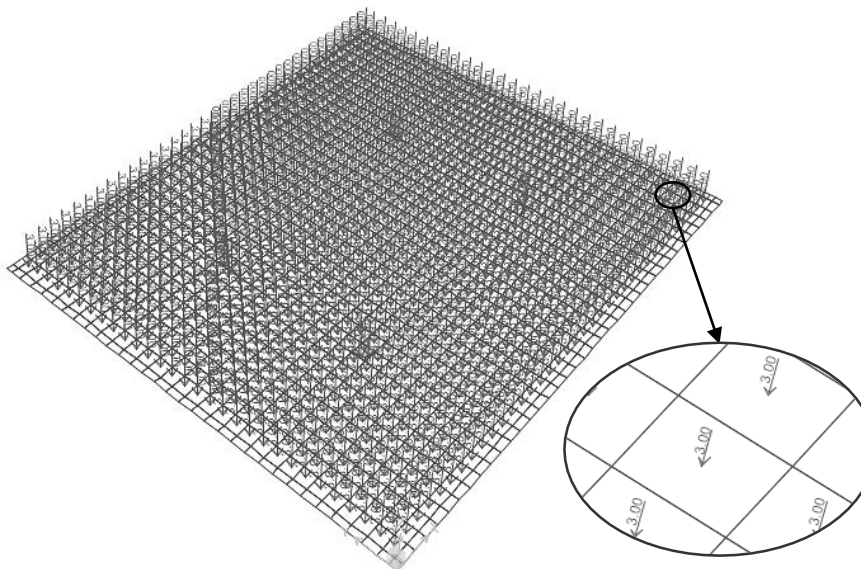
Sobrecarga na Laje de Ensoleiramento
